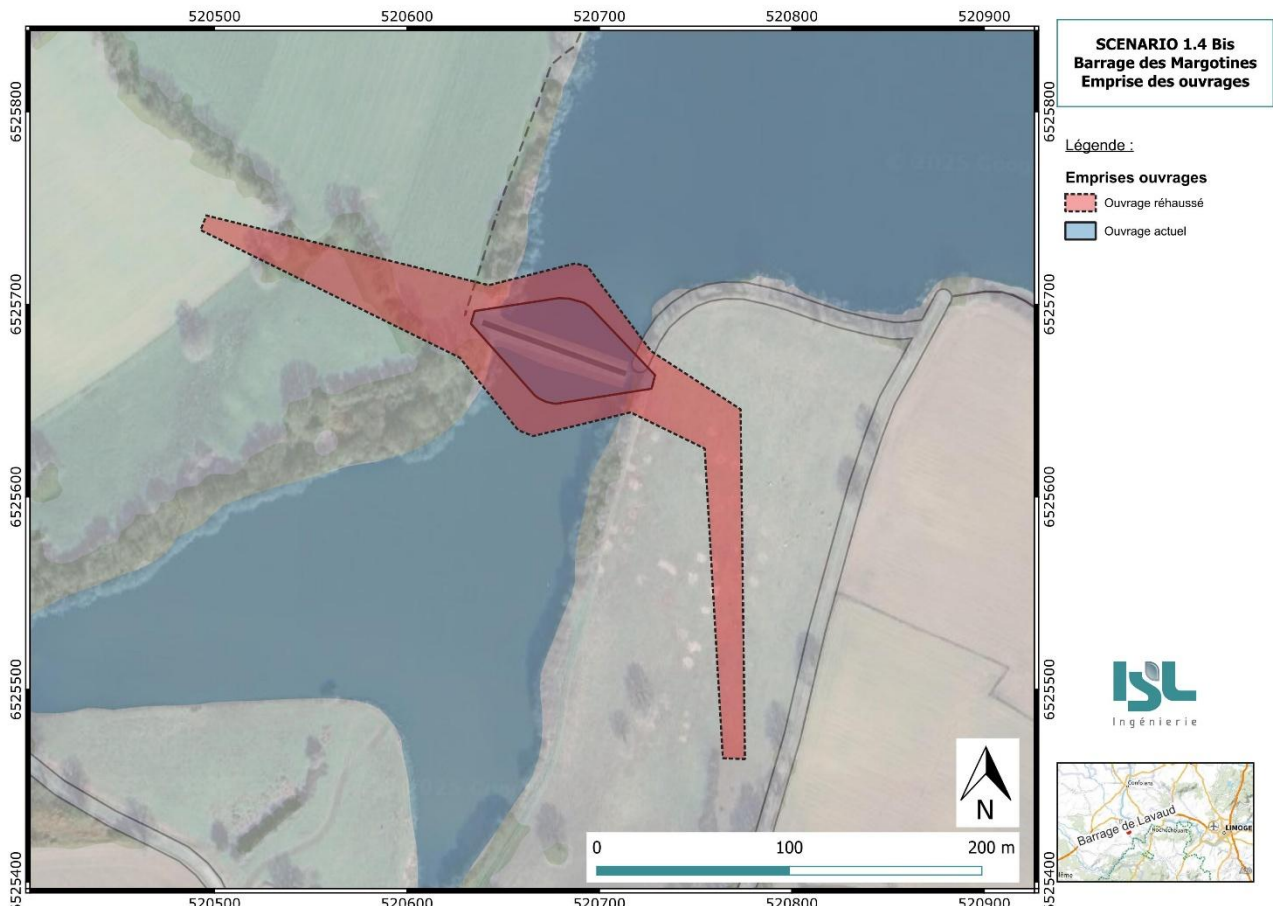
Vue en plan de l'emprise de l'ouvrage réhaussé
